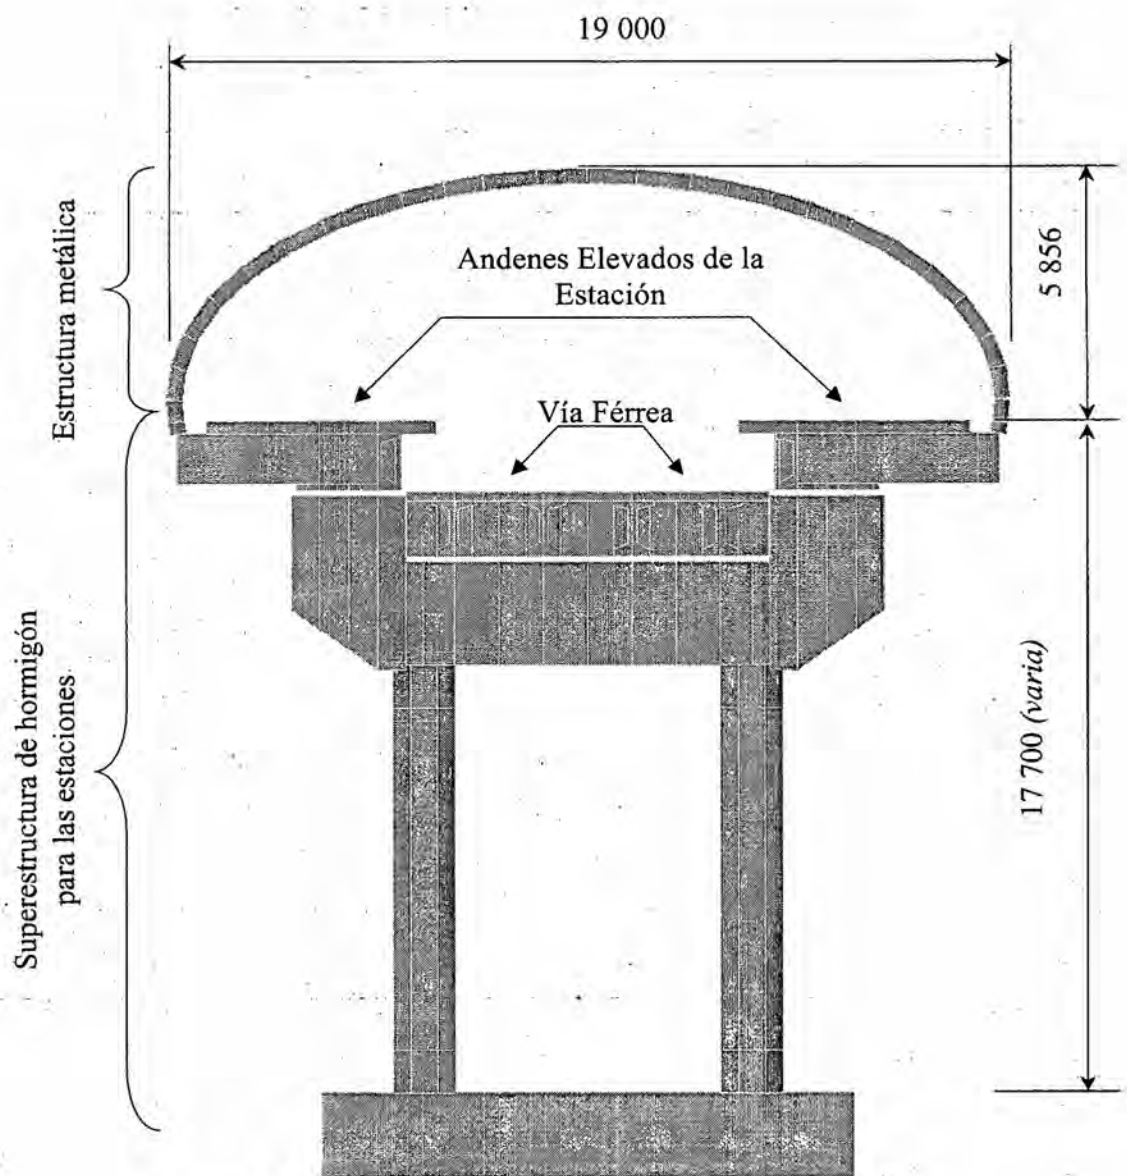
Sección de la Superestructura (Fuente: SAP 2000)
